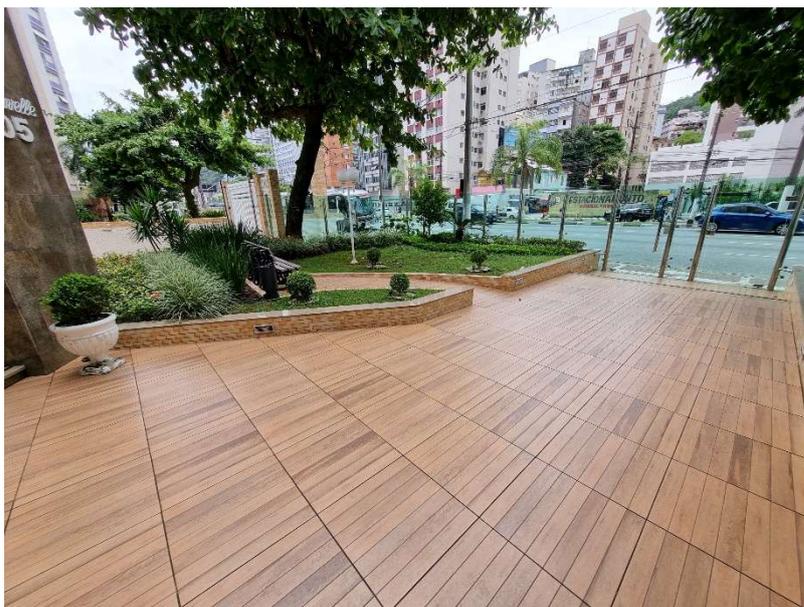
Vista do recuo frontal do Edifício Caravelle.
